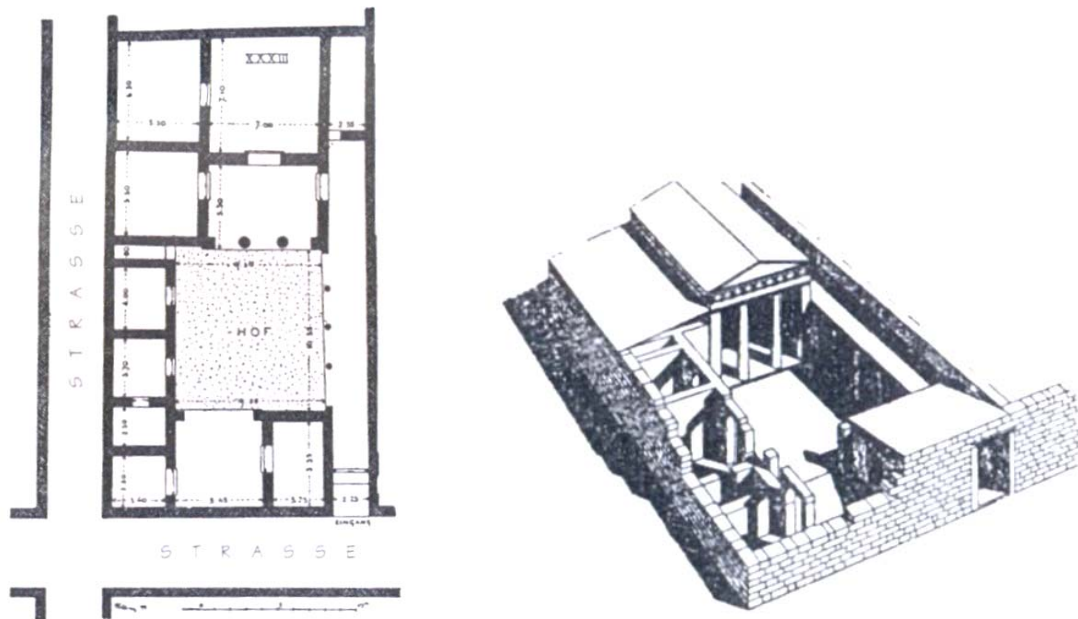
Casa XXXIII, Priene (reconstituição) (Fonte: Robertson, 1997).
